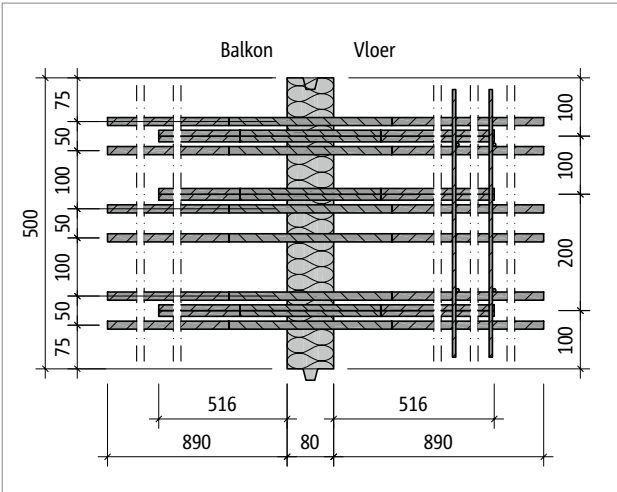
Schöck Isokorf® T type D-MM1-VV1 bij CV35: Doorsnede
